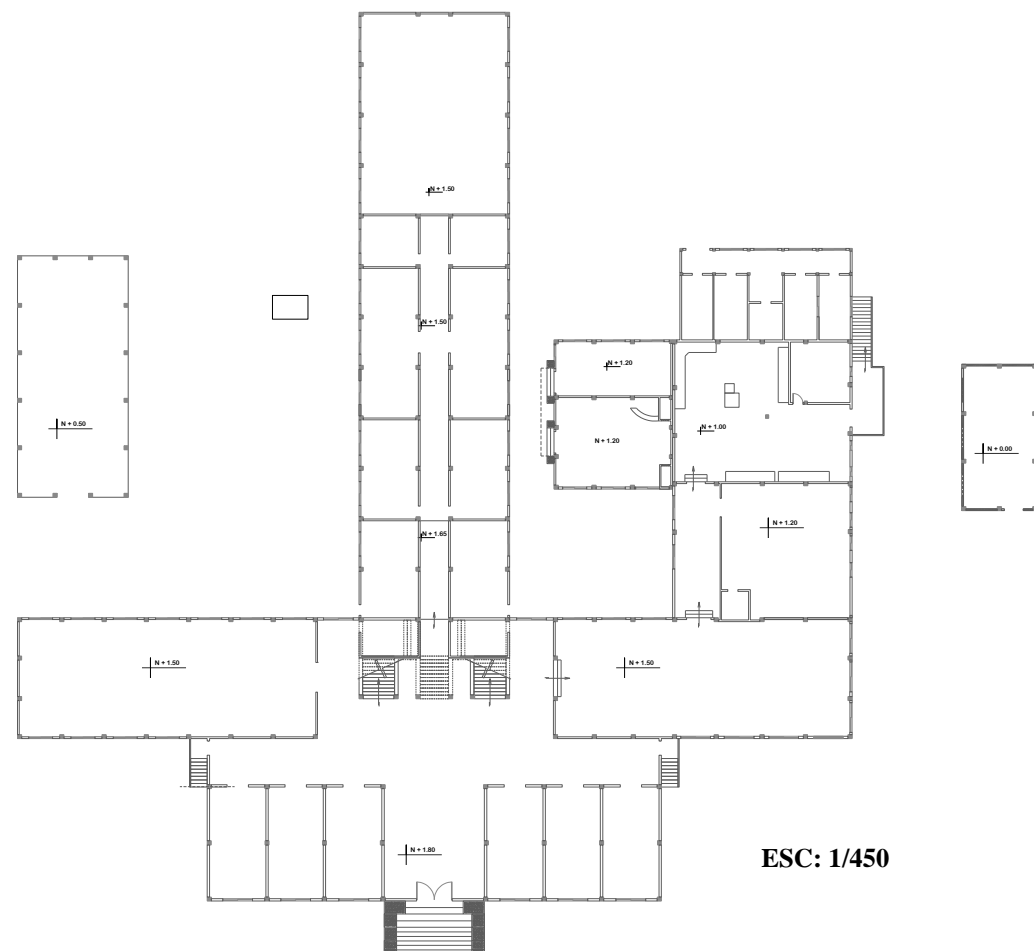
Planta Baja Academia Militar Juan Gómez Rendón.(Academia)
